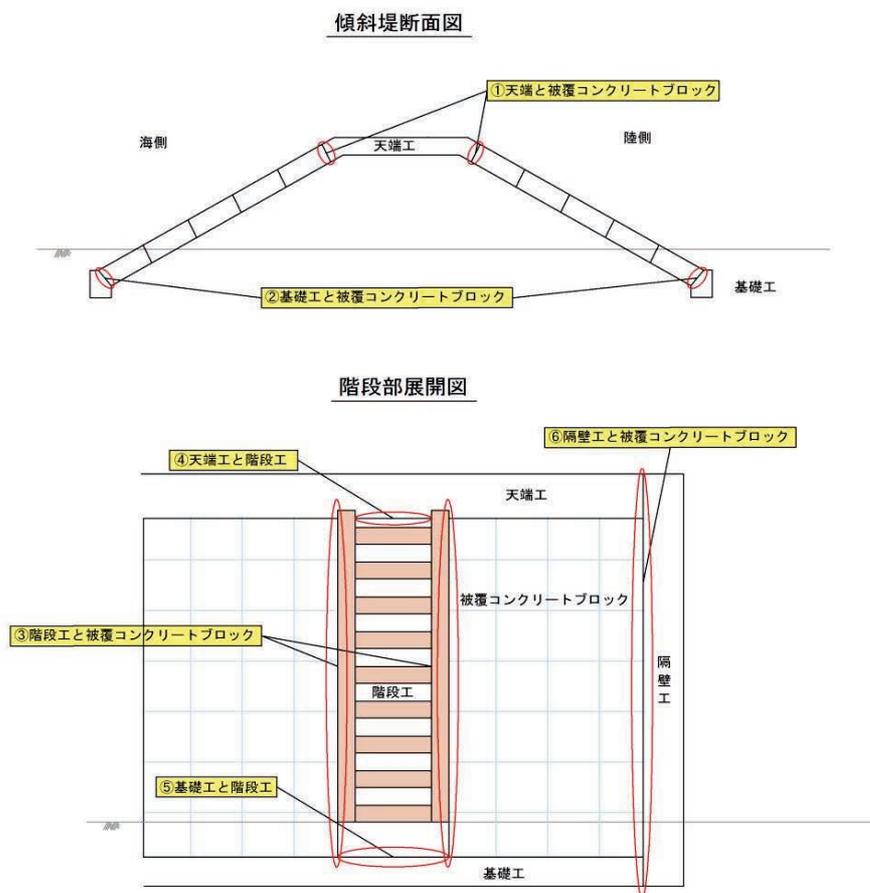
連結方法（不透過型 コンクリートブロック被覆）
